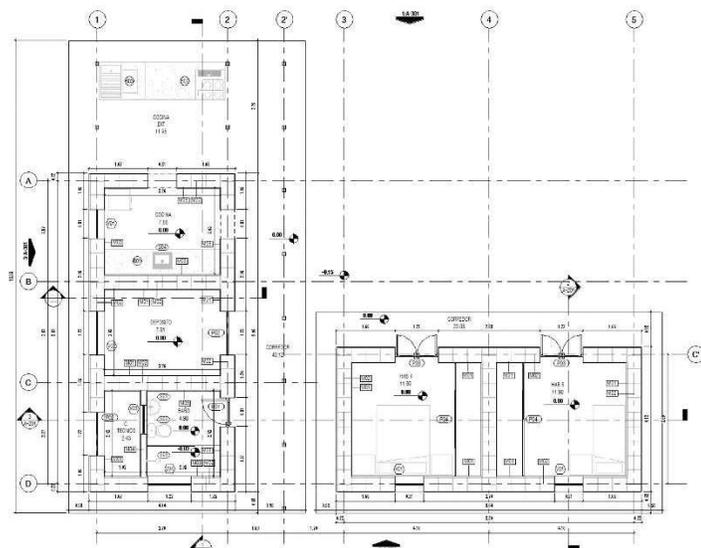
Planta arquitectónica, propuesta alternativa VISR
